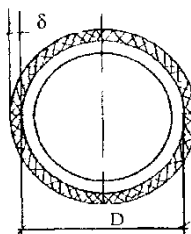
Расчетная схема определения фильтрационных сопротивлений для труб пластмассовых, асбоцементных и др. с круглой перфорацией со сплошной оберткой стеклохолстом
